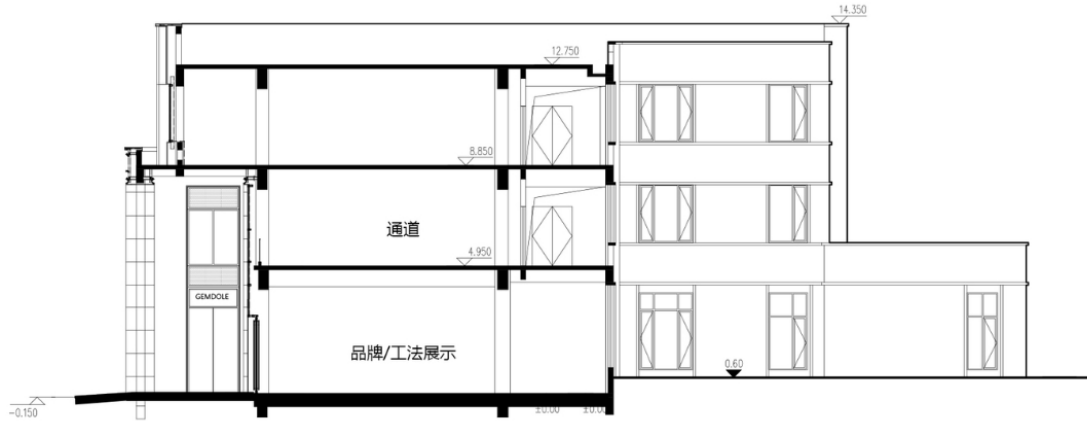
الواجهة الرئيسية لمشروع Metropolislight exhibition center (الباحثين بتصريف عن ، archdaily)
